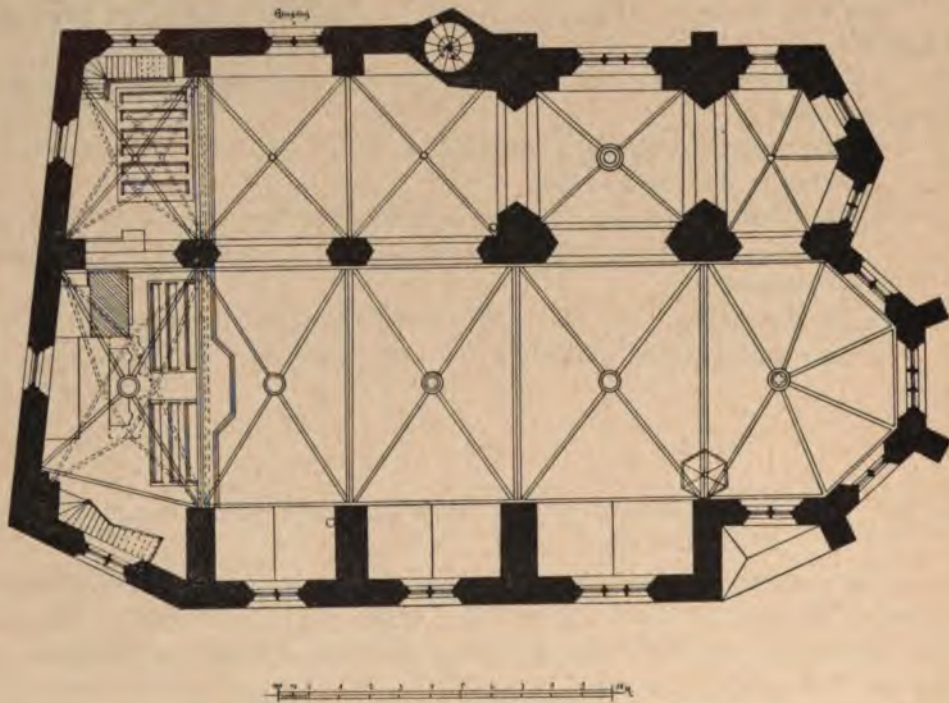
Steeg. Grundriss der evangel. Pfarrkirche.
